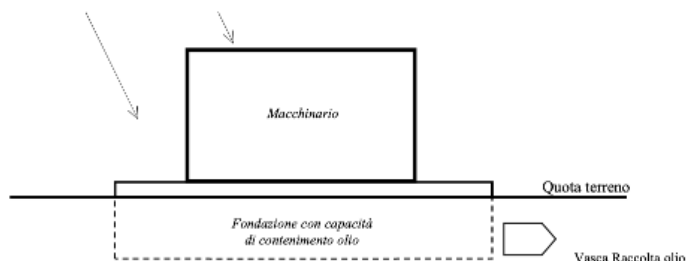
Rappresentazione schematica del sistema Vasca-Fondazione
